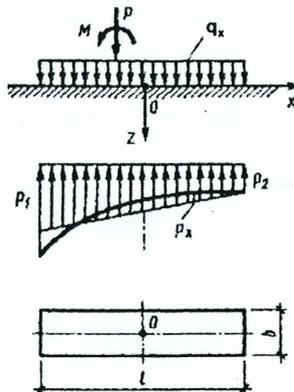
Предварительный подбор сечения фундаментной балки
